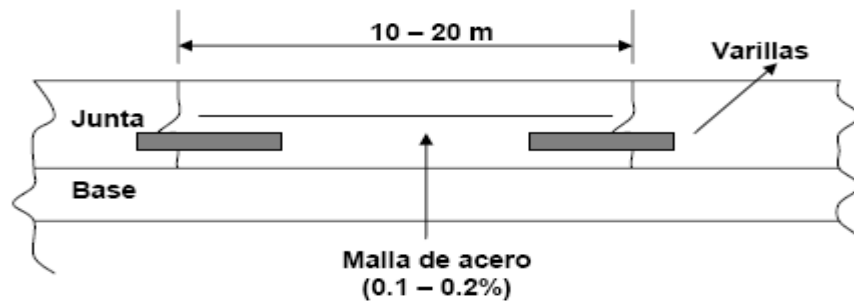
Pavimento de concreto con refuerzo discontinuo (JRCP)
